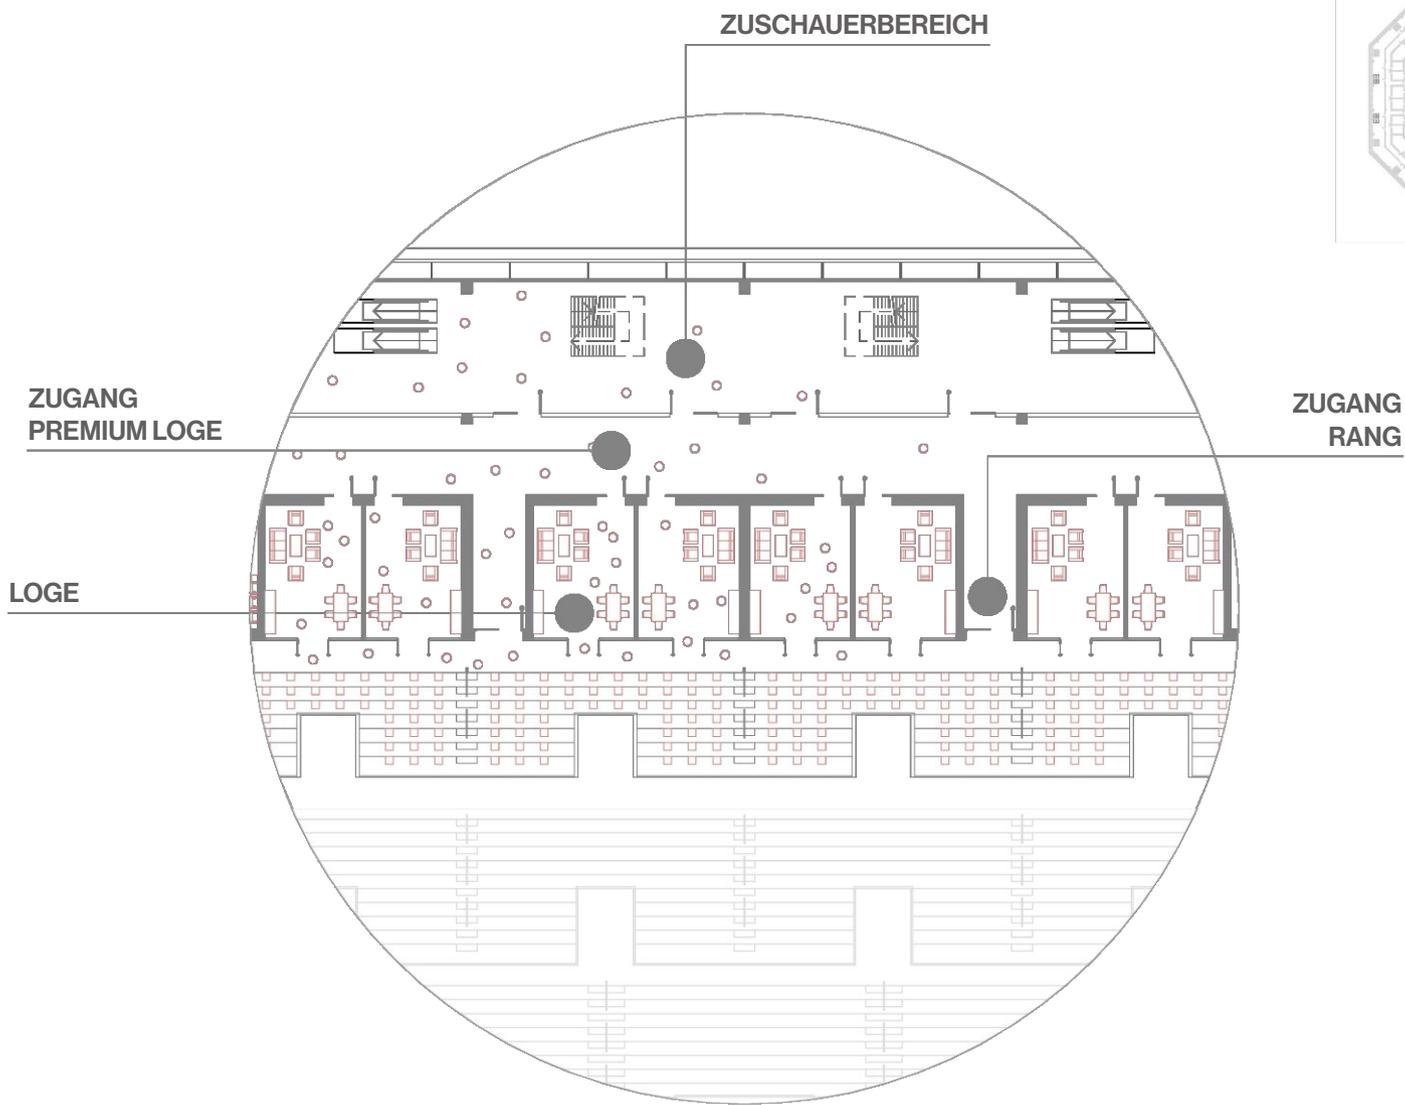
Grundriss 3. OG Zoom 1
